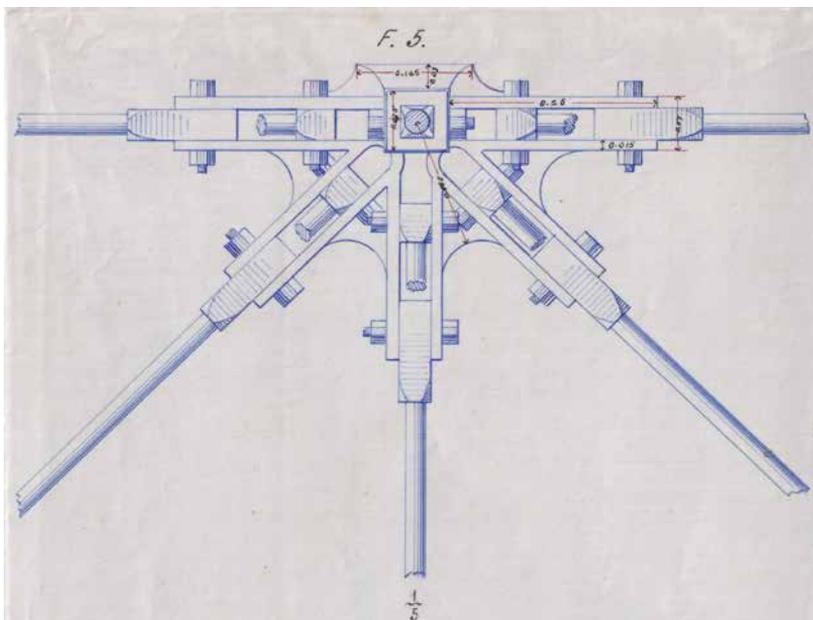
Detalle del encuentro de los tirantes de una cubierta diseñado por el Capitán Guillermo de Aubarede para el Proyecto de un cuartel para un batallón en la Habana, 1888. [AMM. Sign. CUB-164/7]
